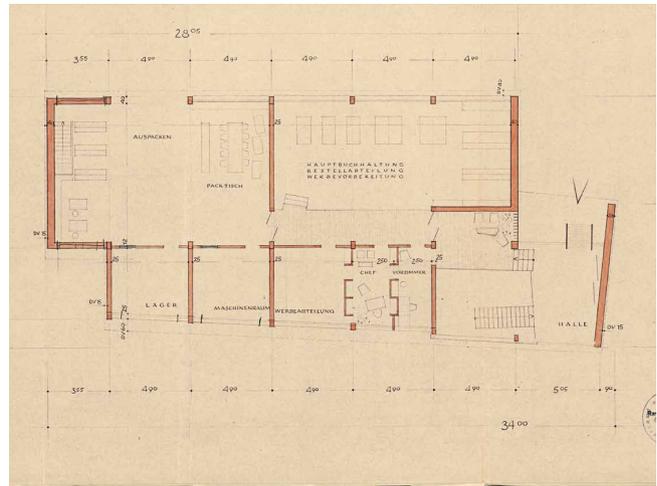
Rolf Gutbrod, Planung zur Verlagsbuchhandlung Rieck, Grundriss, 1953
